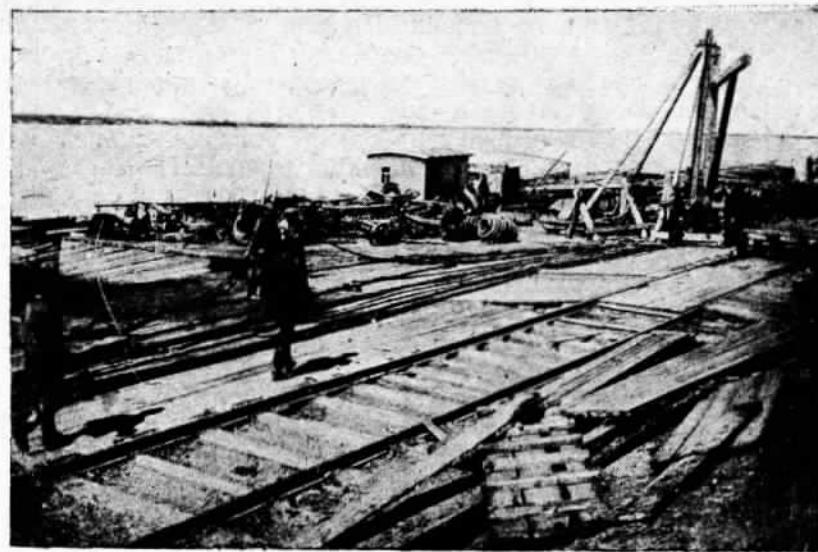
Такелажная база. Схема базы приведена на рис. 102. Средняя площадка, через которую проходит ж.-д. ветка. На площадке установлен кран для погрузки и выгрузки такелажа с железной дороги
